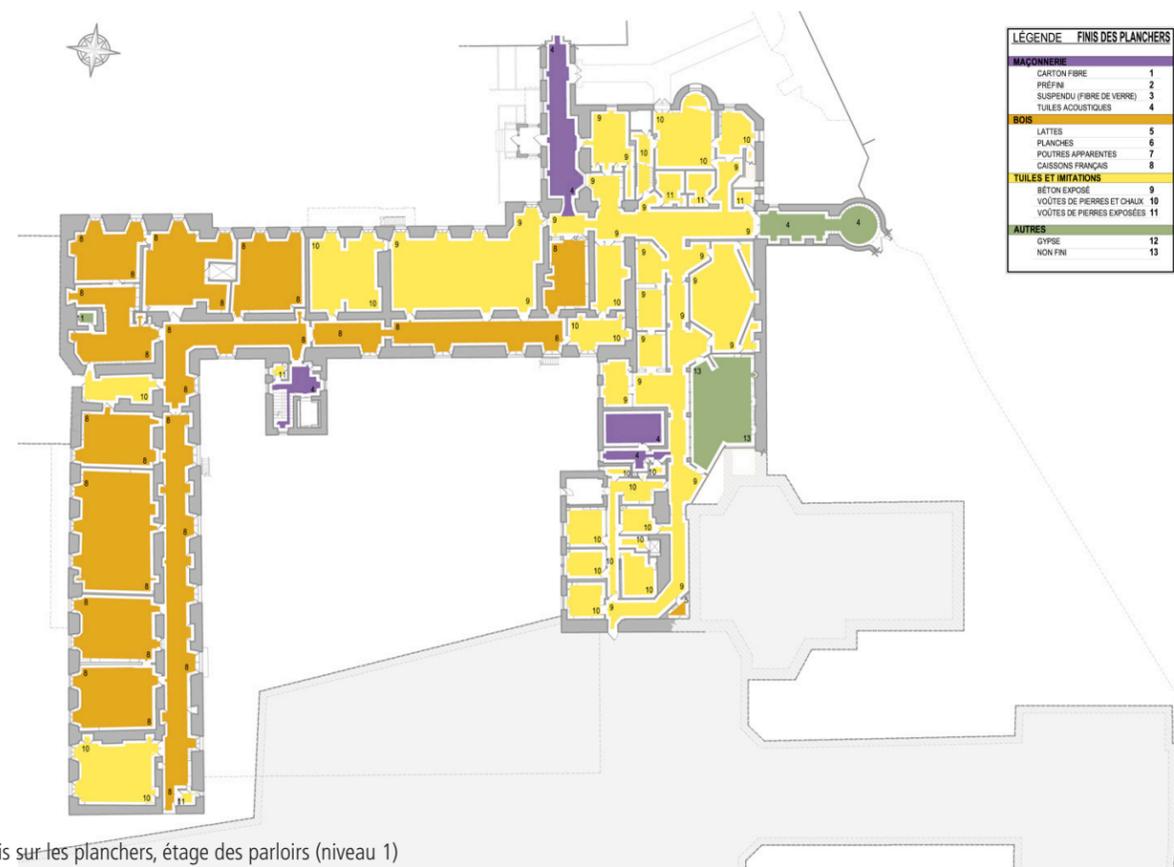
Plan des fins sur les planchers, étage des parlours (niveau 1)
